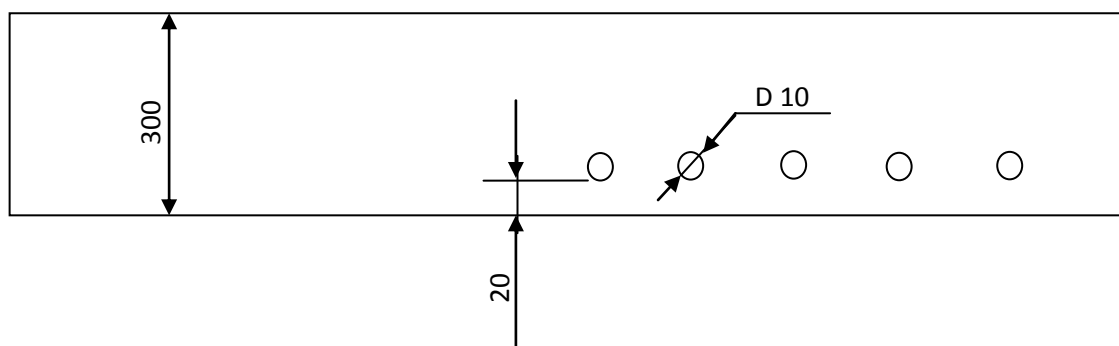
Размеры и схема армирования железобетонного перекрытия
